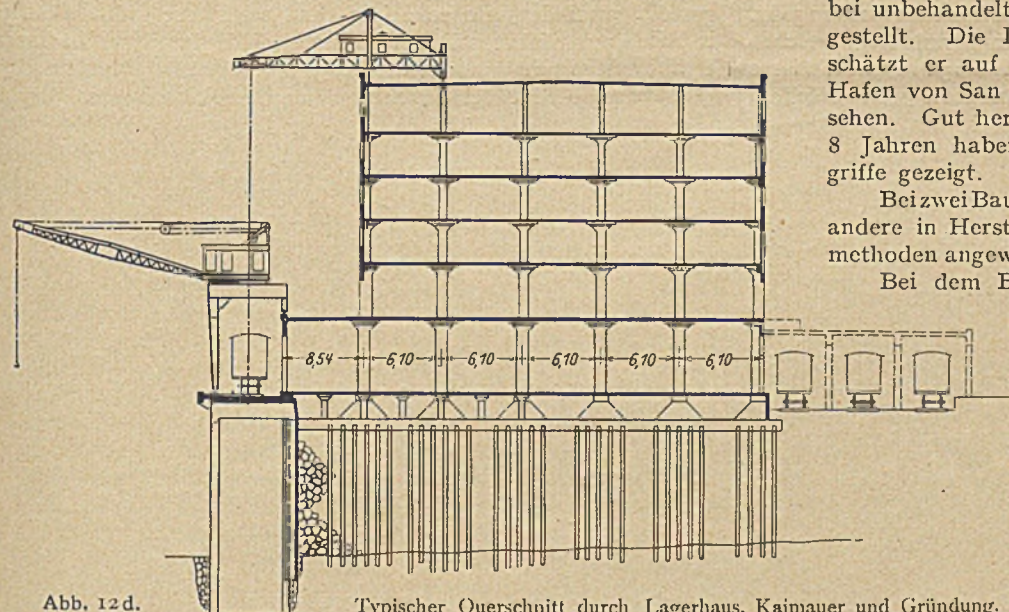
d. Typischer Querschnitt durch Lagerhaus, Kaimauer und Gründung.
